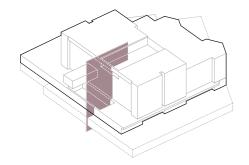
Sección transversal detalle. Fuente: Elaboración propia
